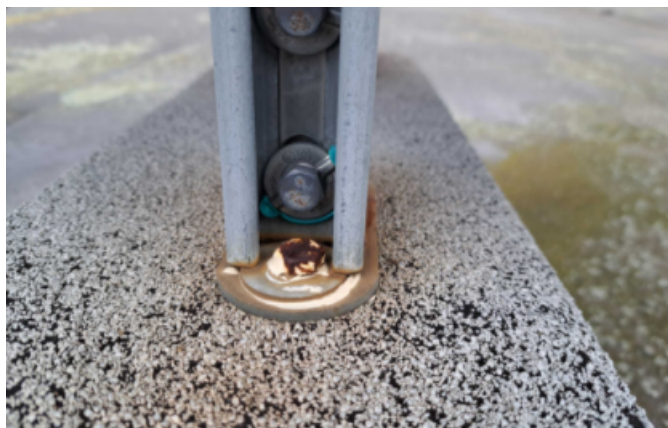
/ Mechanické uchycení konstrukce skrz hydroizolaci, ochranný tmel je silně zvětřen
